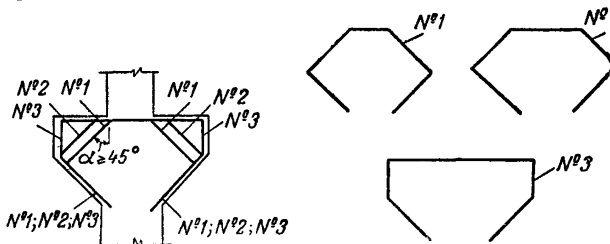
Армирование консолей колонн вязаной арматурой; № 1, № 2 и № 3 — номера стержней
